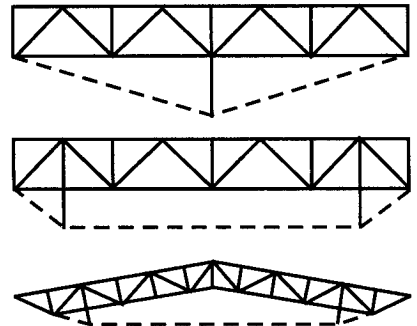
Схеми ферм із затяжками за межами їх габариту
